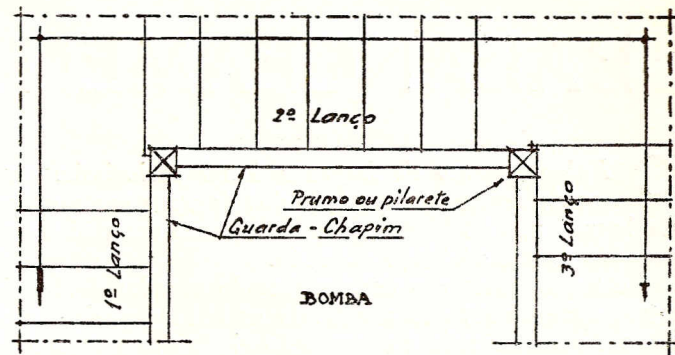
PLANTA DA ESCADA SEM PESCOÇO DE CAVALO
